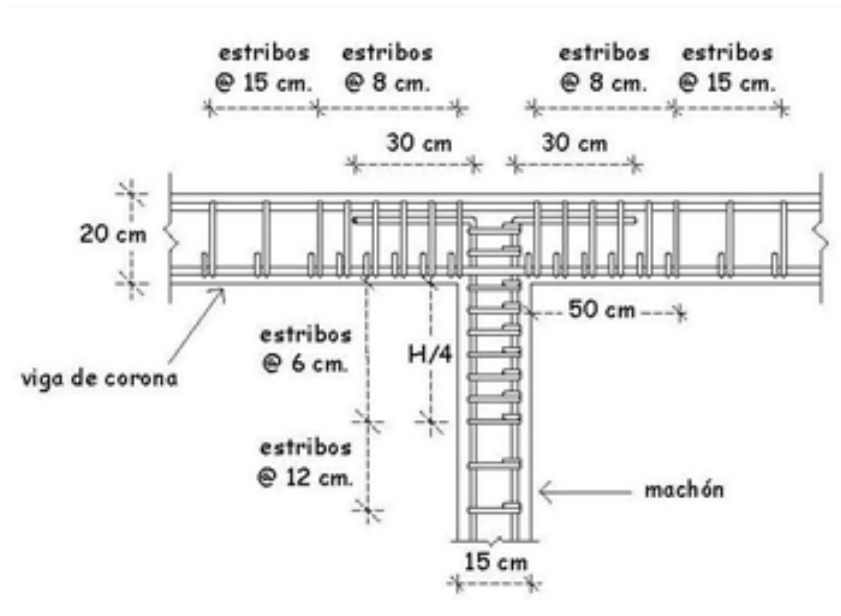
Detalle del refuerzo en la zona del nudo pilar-cadena (Lafuente, 2007)
